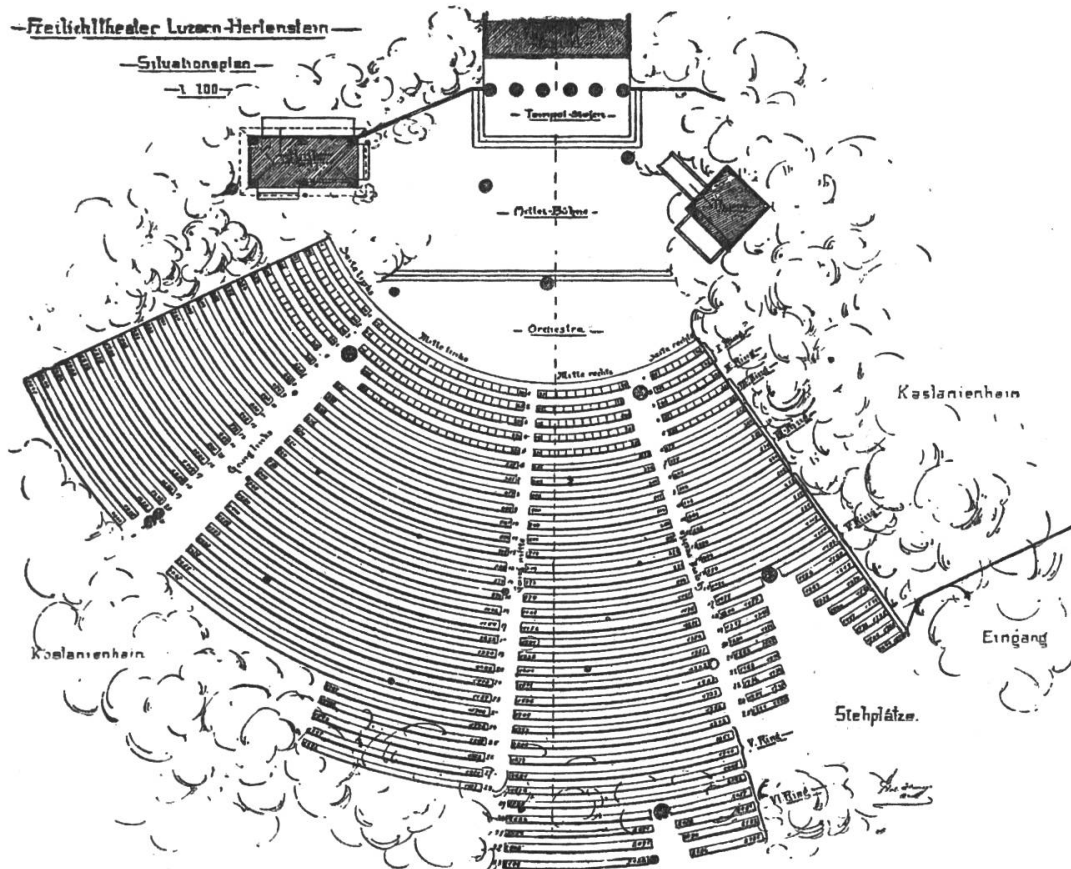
Freilichtbühne Hertenstein 1909. Grundriss.
